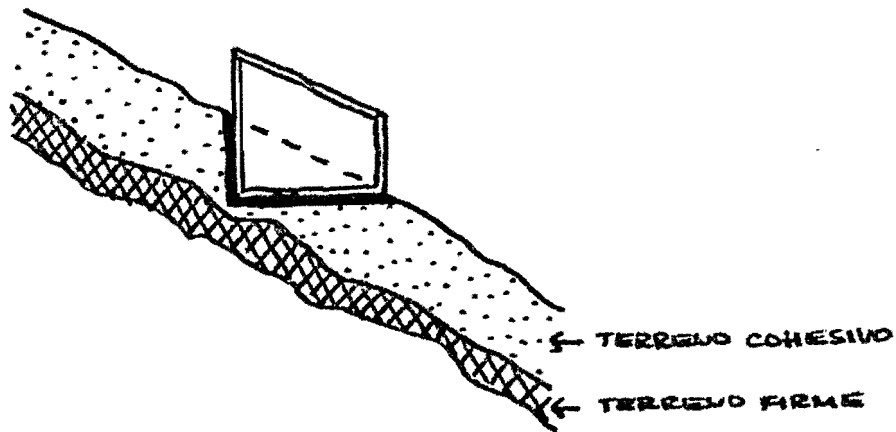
ESTRUCTURA SOBRE BANQUEO CON PELIGRO DE DESLIZAMIENTO
